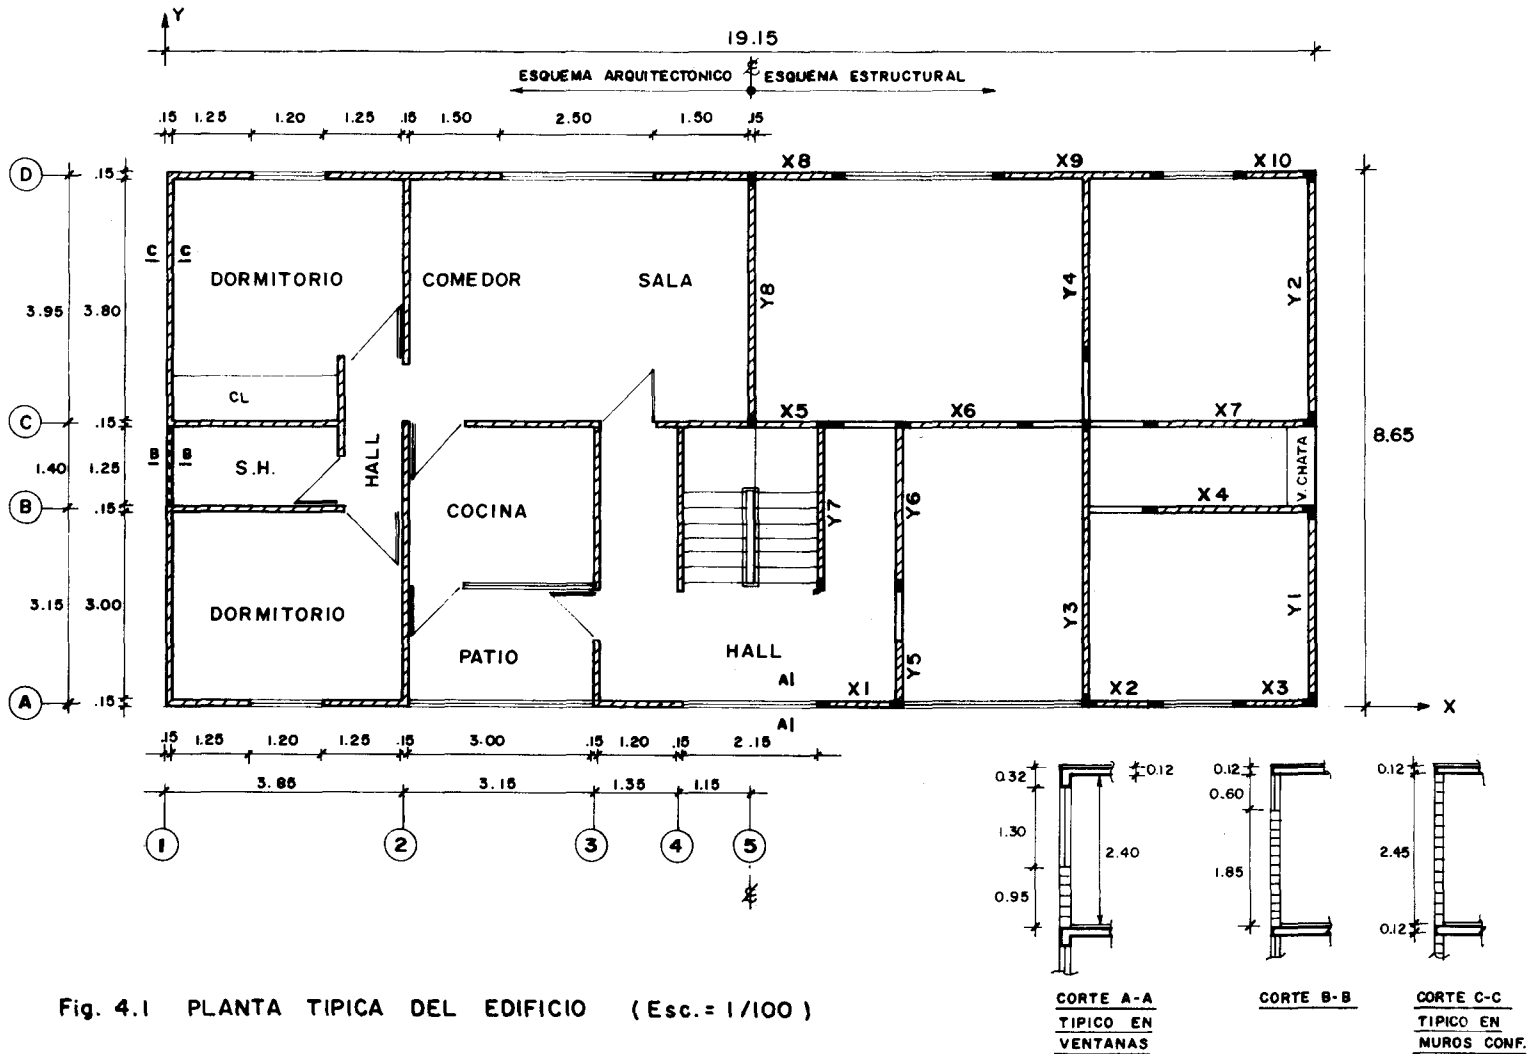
PLANTA TIPICA DEL EDIFICIO (Esc. = 1/100)
